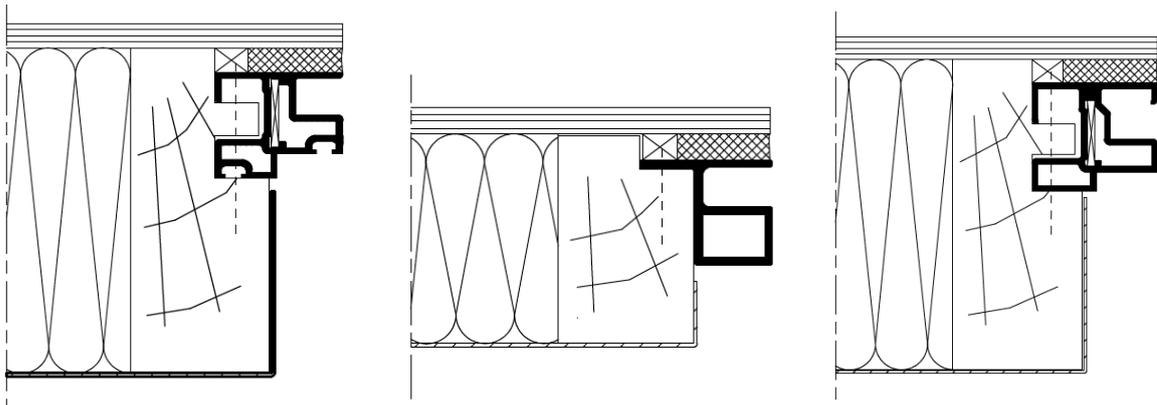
Coupes verticales– Exemples de panneaux à lameaux
